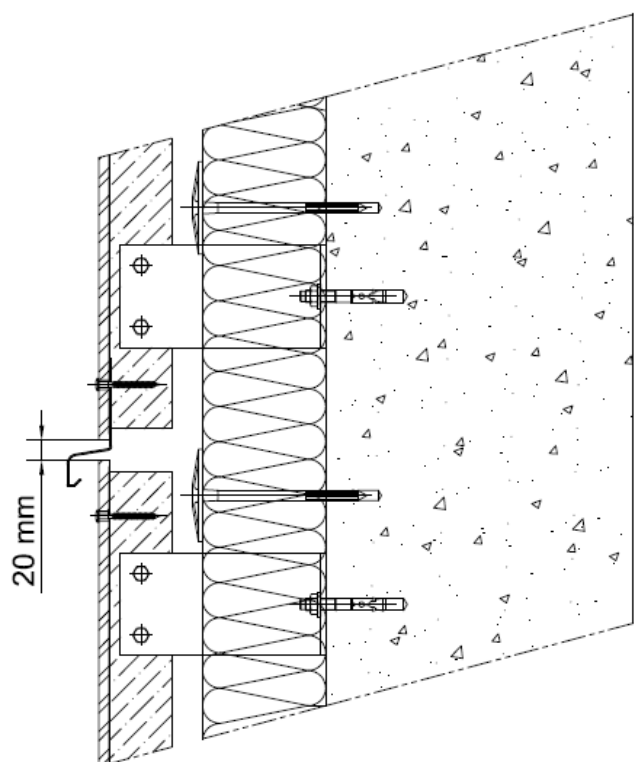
Sección vertical. Junta horizontal entre paneles con perfil auxiliar.
